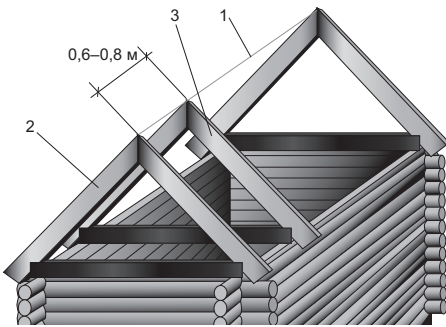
Стропильные фермы устанавливаются после монтажа крайних ферм: 1 — шнур; 2 — крайняя стропильная ферма; 3 — средняя стропильная ферма
